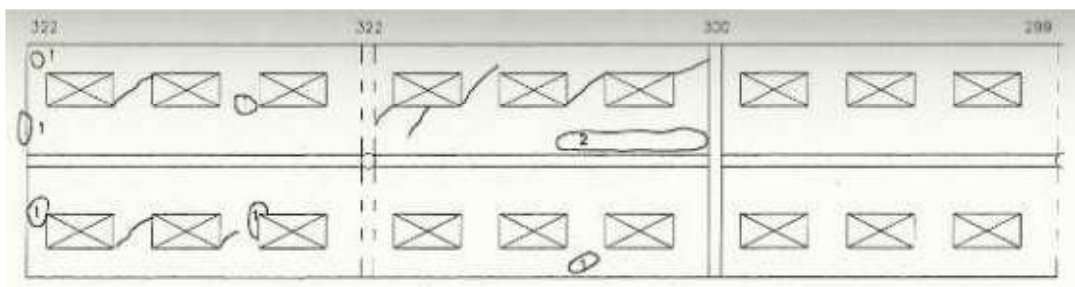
Mapeamento das Vigas Vierendeel - Eixo 1 – Ano 2000.
